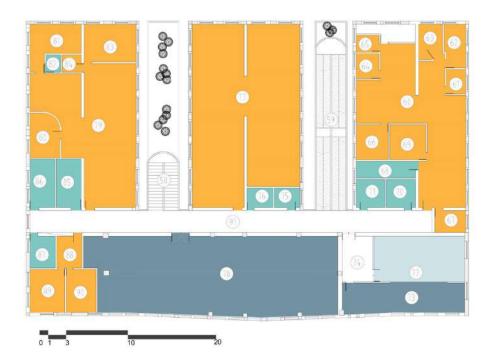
Planta 1 Bloque 38. Fuente: Equipo de diagnóstico.
